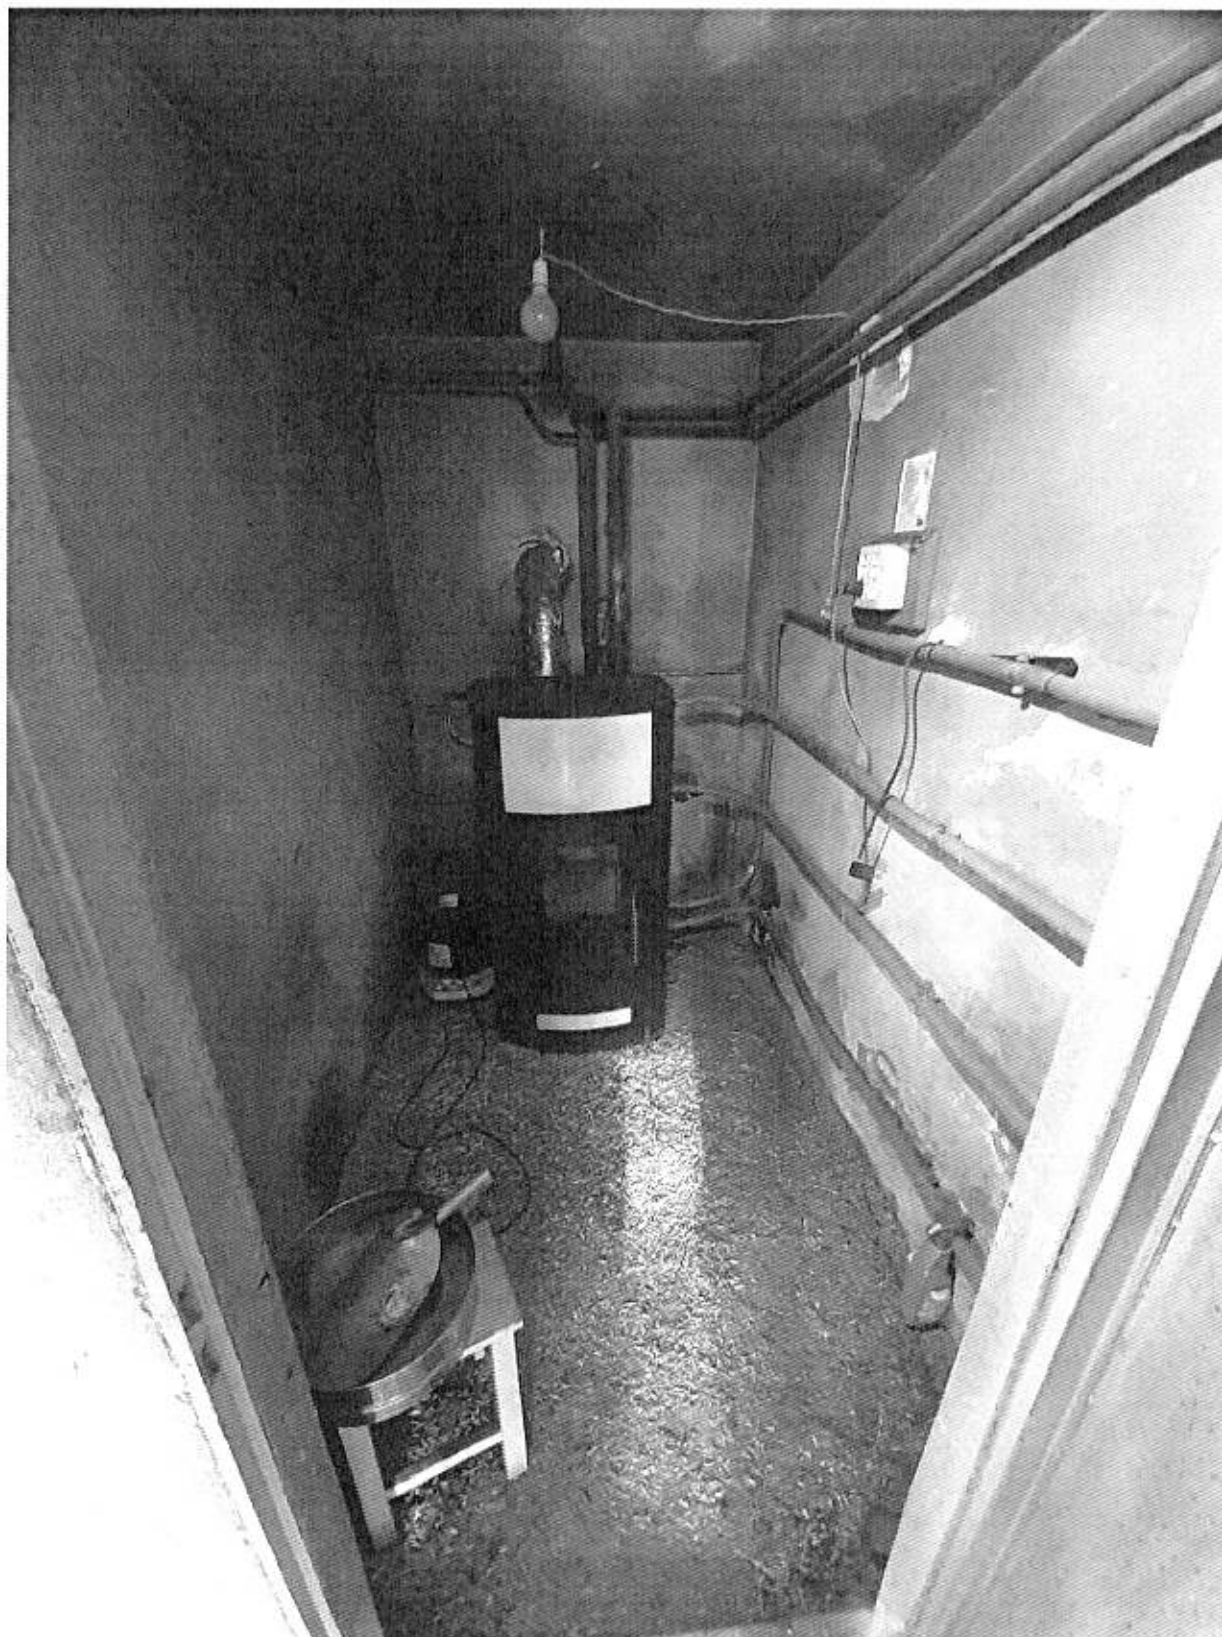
Piano Terra - Centrale Termica (pellet)
